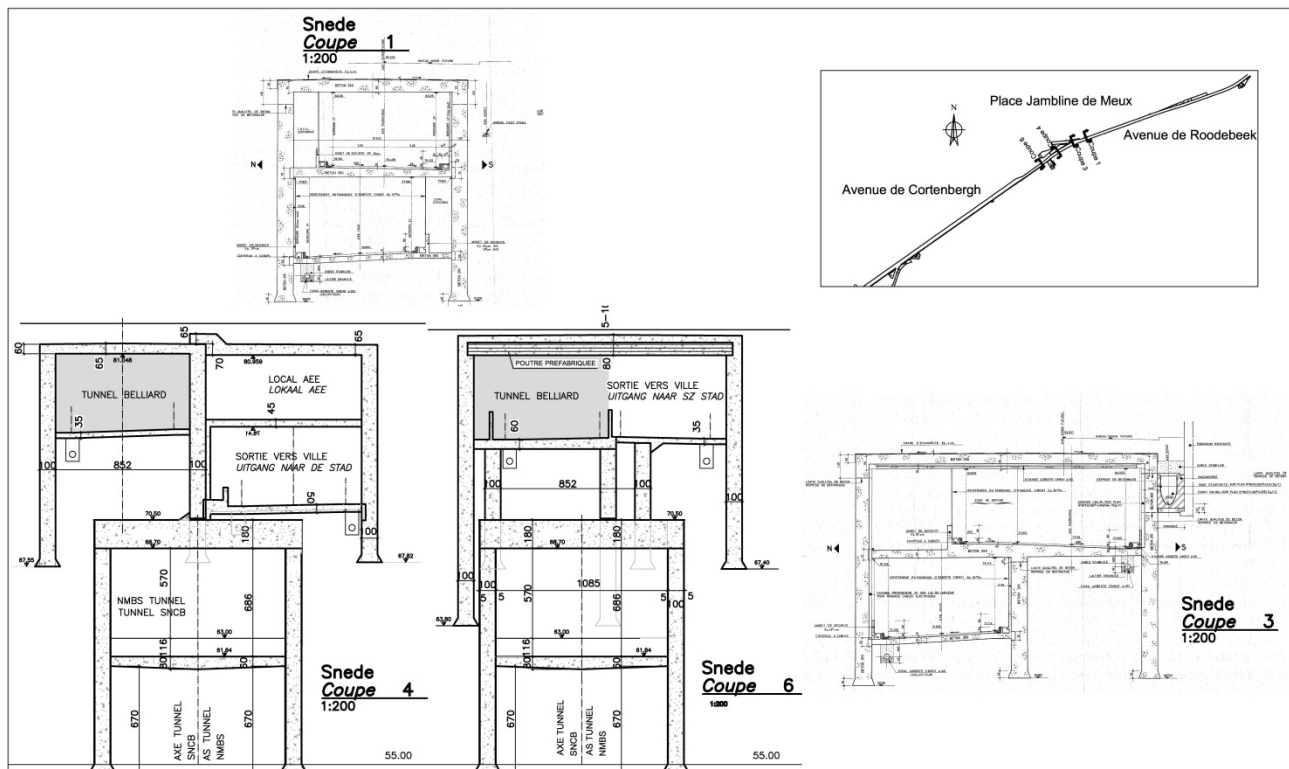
tunnel Belliard – profil en travers et coupes transversales caractéristiques
